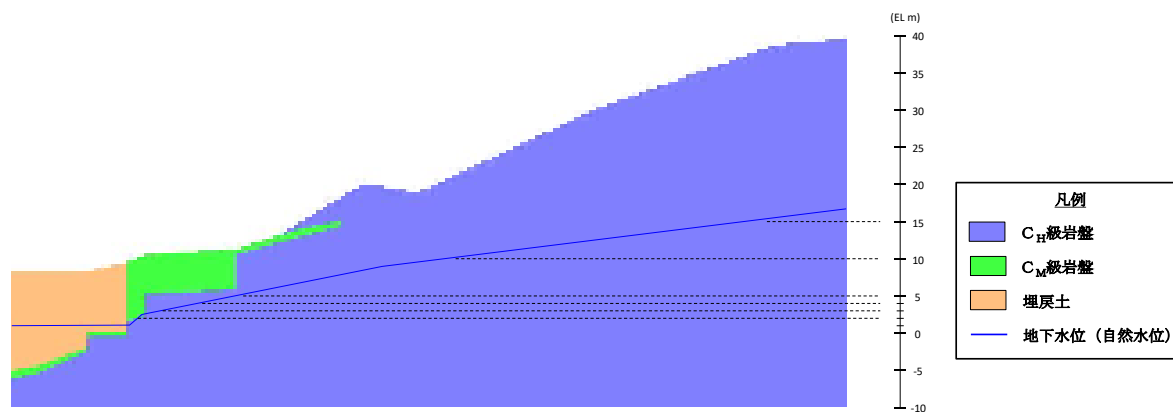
解析モデル断面図 (図 3.3-16 a-a' 断面)
